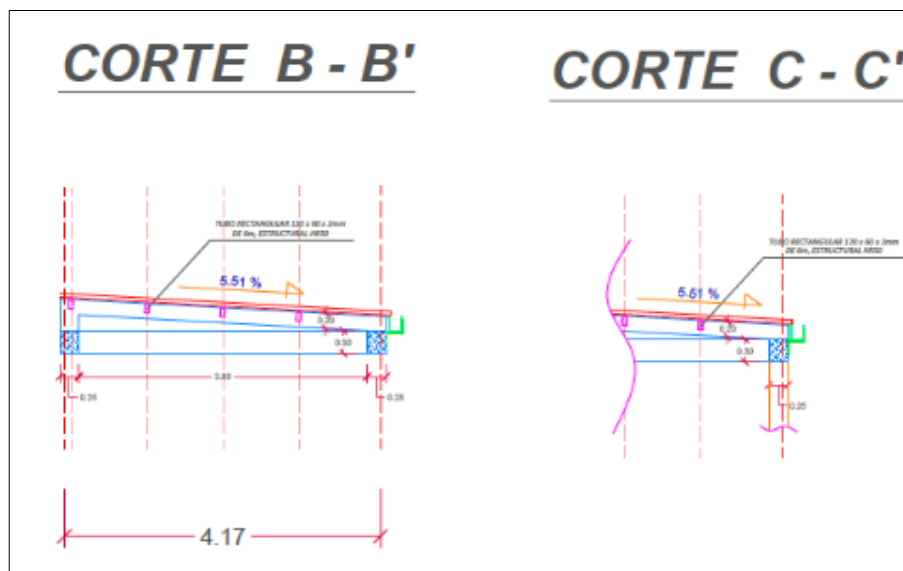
Corte arquitectónico B-B', C-C'' de la estructura 3 del Centro Vida.
